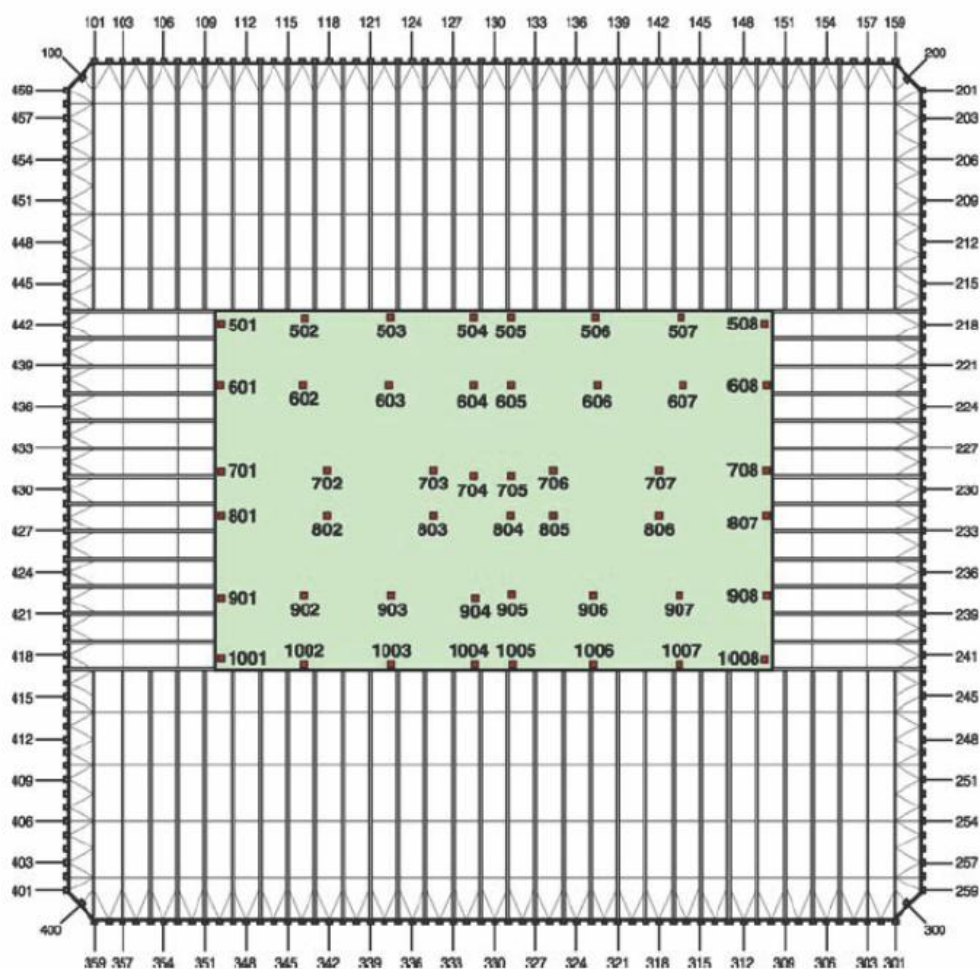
Planta estrutural da torre 1 do WTC [20].
